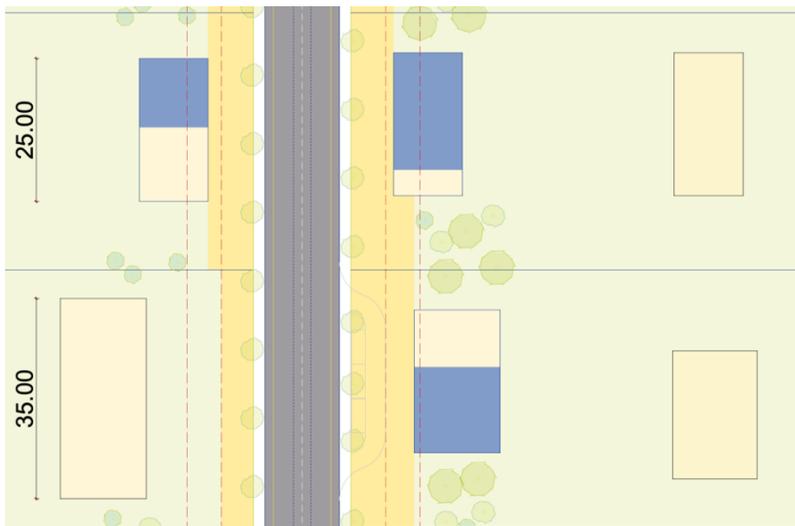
mögliche Anordnung im Grundriss (Darstellung unten links mit bestehender Gebäudelänge von 35 m (folglich ohne BMZ-Erhöhung und Höhenbonus)
